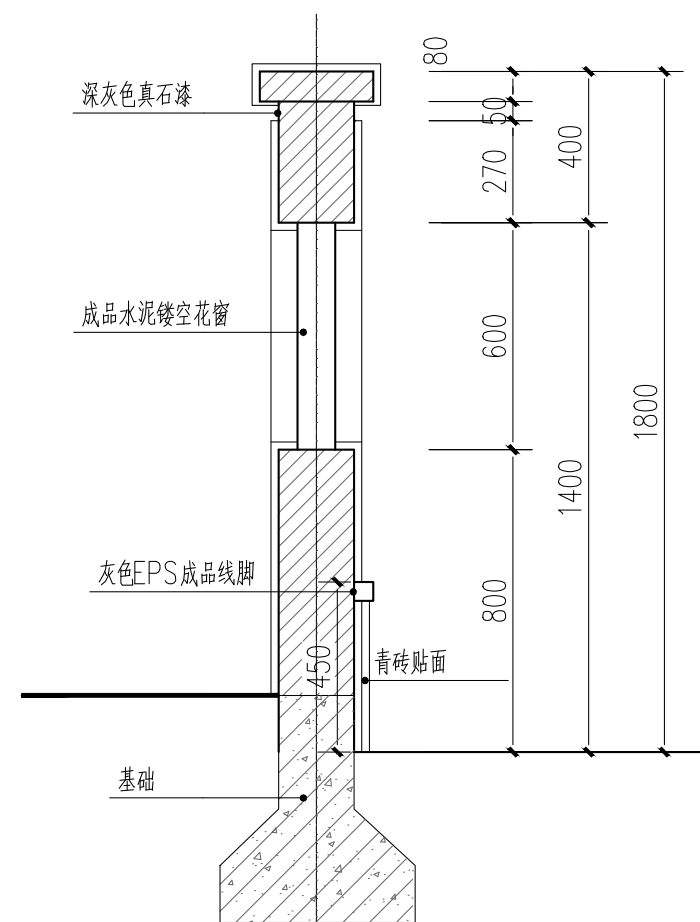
围墙大样	图纸编号	建详-16	建筑
